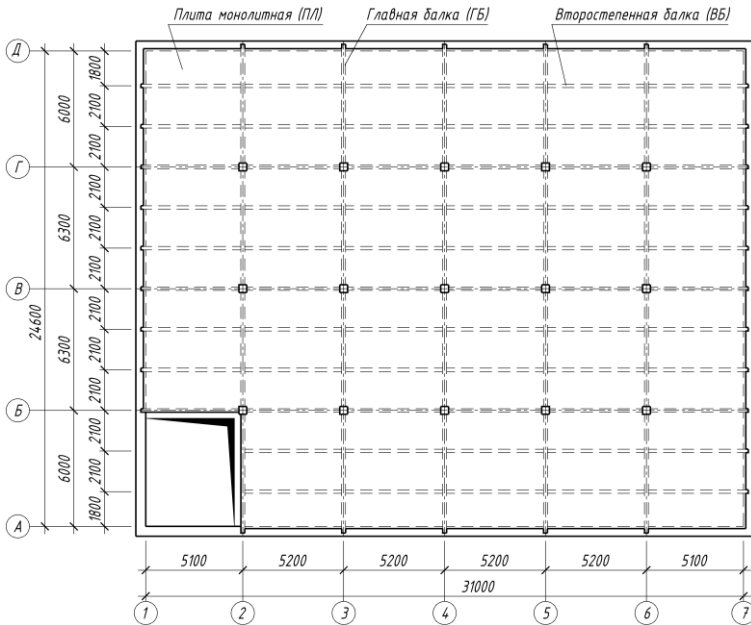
Конструктивная схема перекрытия – вариант 1
